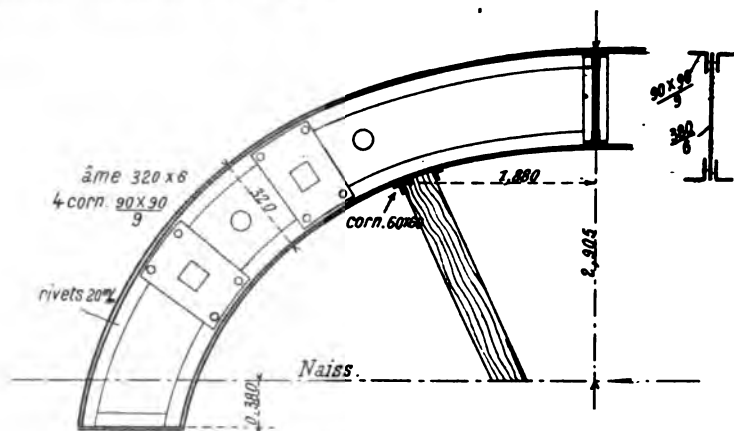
Élévation d'un demi-cintre et coupe transversale.
